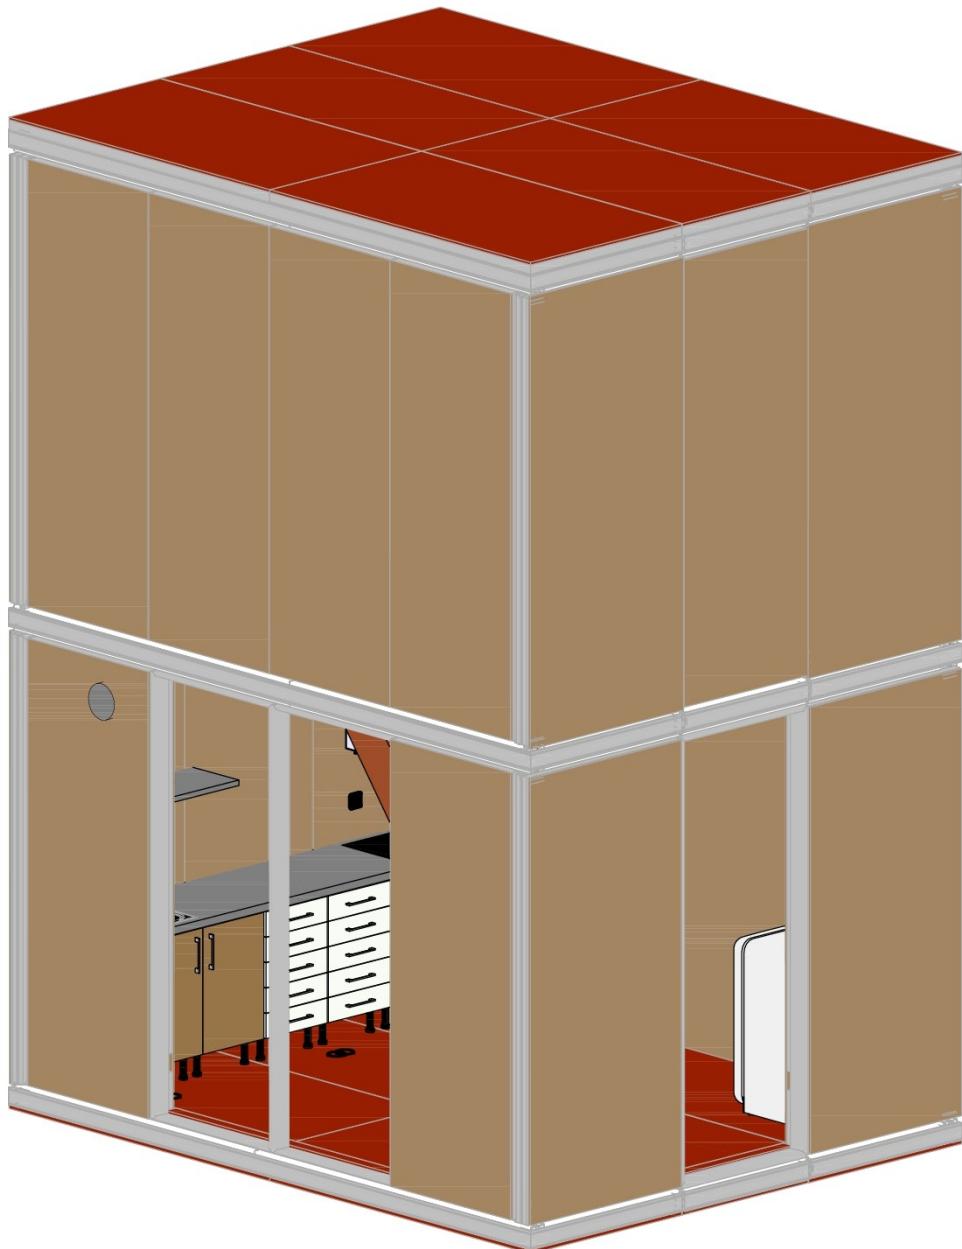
Axonometria Construção Piloto – Metodologia BIM
